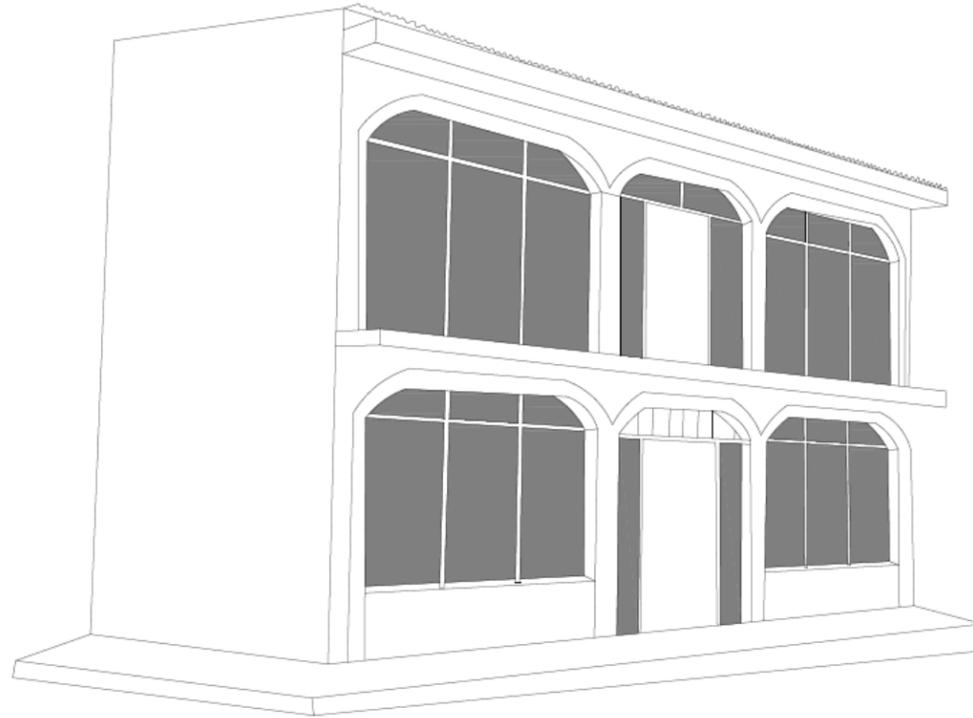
Simetría en elevación. Fuente: equipo de trabajo
